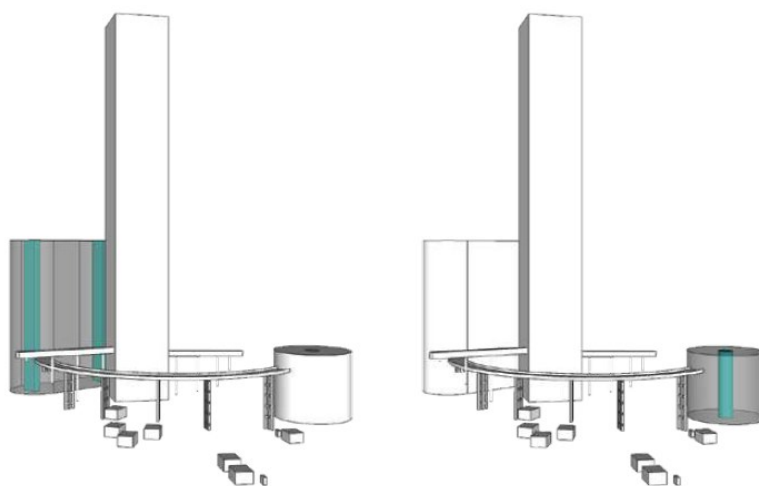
Esquema de espacio servido y servidor de torre de aparcamiento y torre de aparcamiento e ingreso (Buenaño, 2020)
